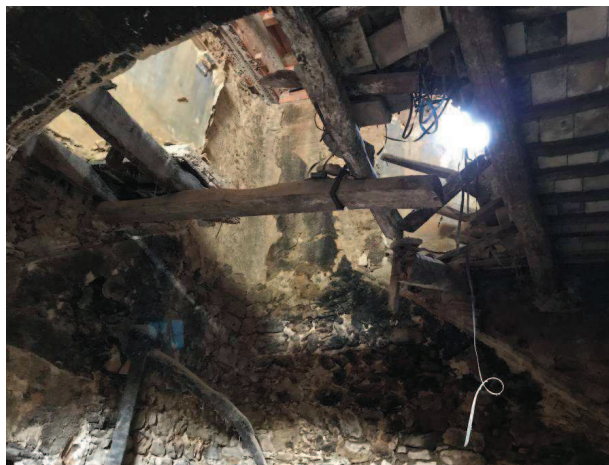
Sostre de planta baixa que s'ha de retirar.
